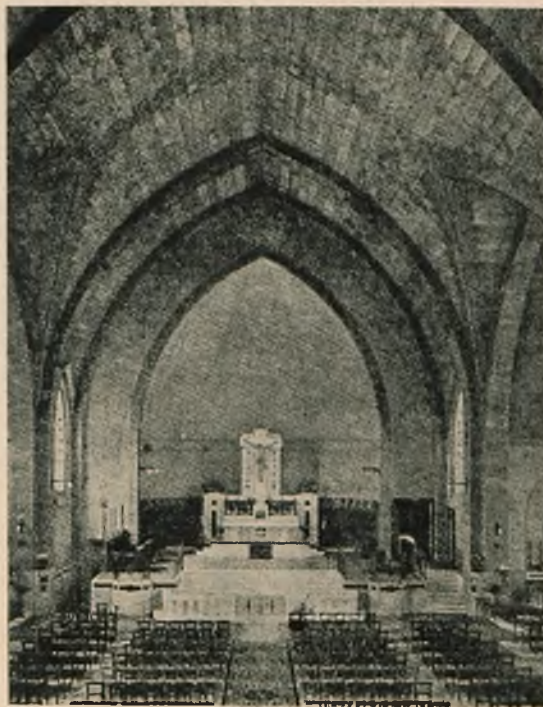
Wnętrze kościoła w Fontenay; widać doskonale konstrukcję ścian i stropu z gotowych elementów żelbetonowych.
